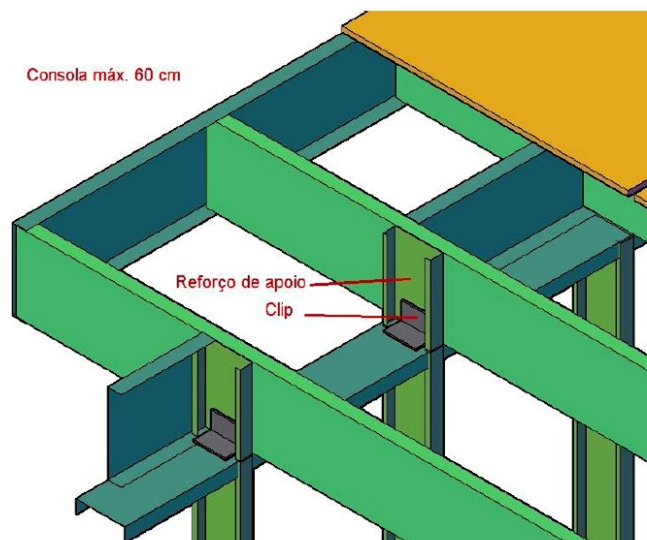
Fixação de pavimento em consola sobre parede estrutural
